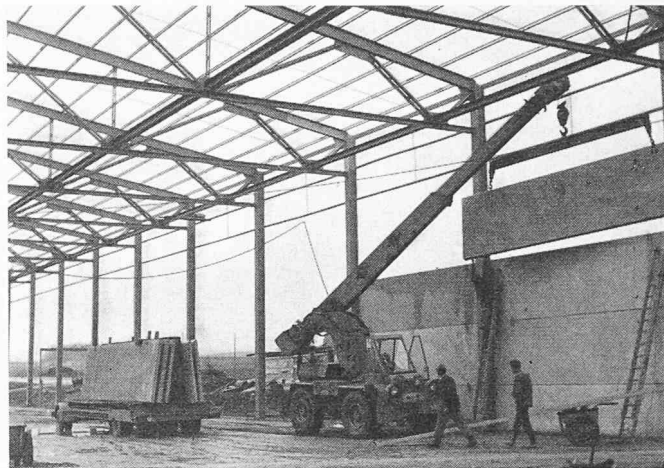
Vorfabrizierte Betonaussenwandplatten werden mit einem Pneuokran an die Stahlkonstruktion montiert
